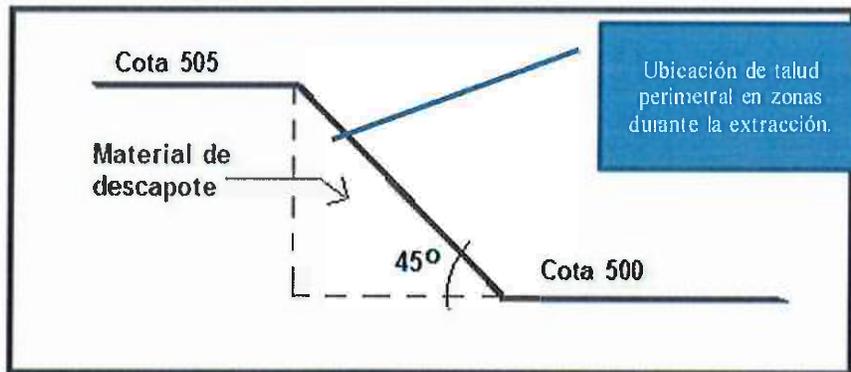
Ubicación de talud perimetral en la zona de extracción.
